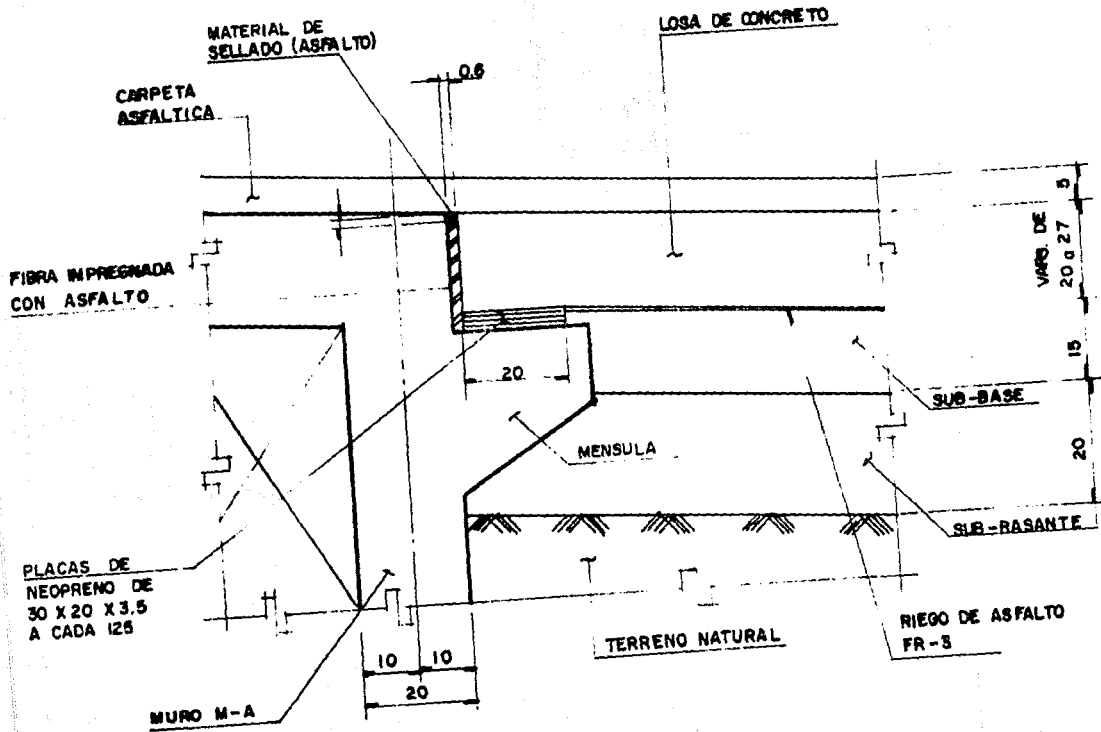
JUNTA AIREPLEEN-TERRAPLEN.
